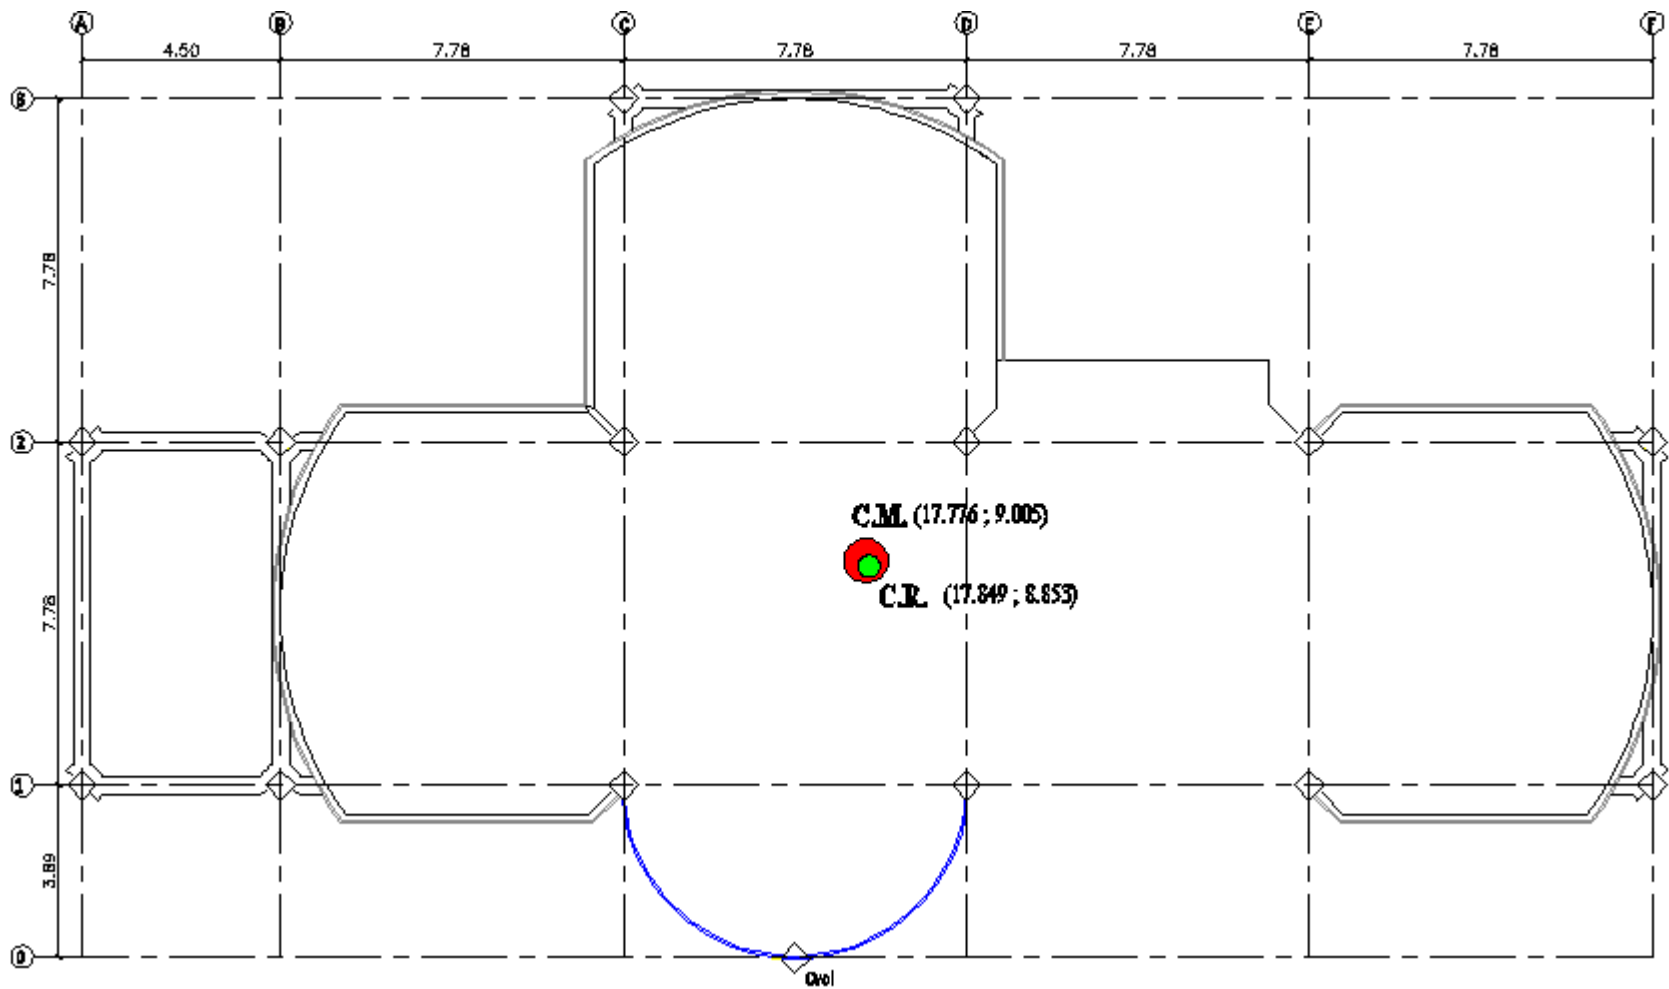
Centro de Masas y Rigidez de la Losa N+3.08
